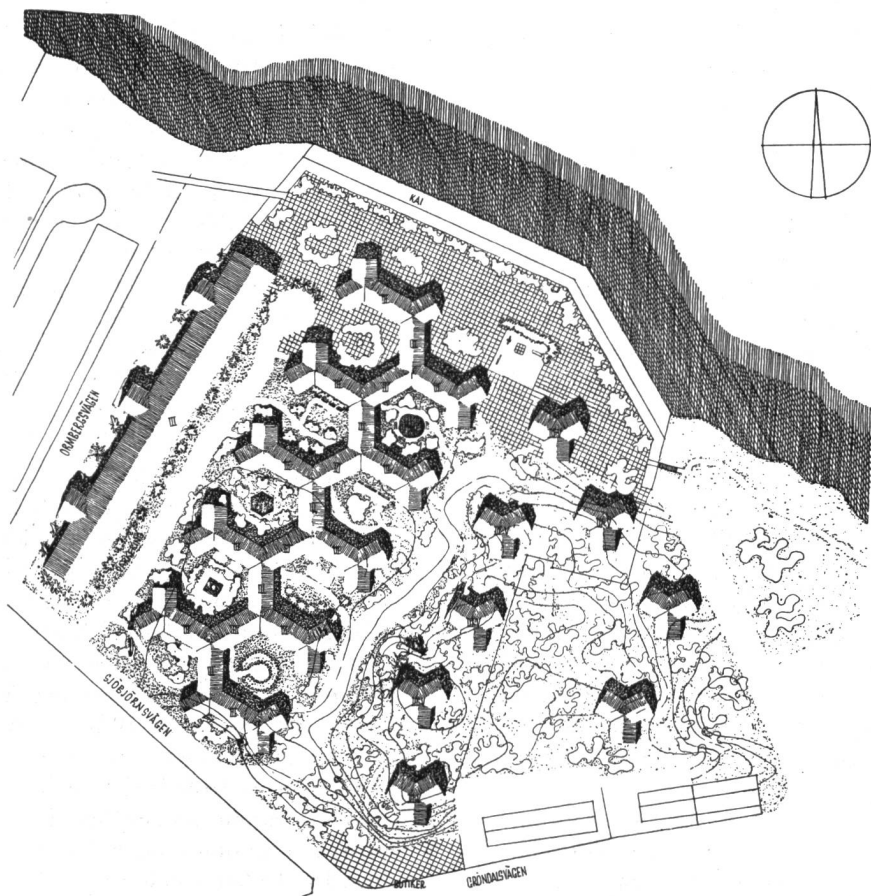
«Sternhaus»-Siedlung in Stockholm. Dreistöckige Hausgruppe mit sechseckigen Gartenhöfen und fünfstöckigen Hochhäusern. Element siehe Abb. 5.
